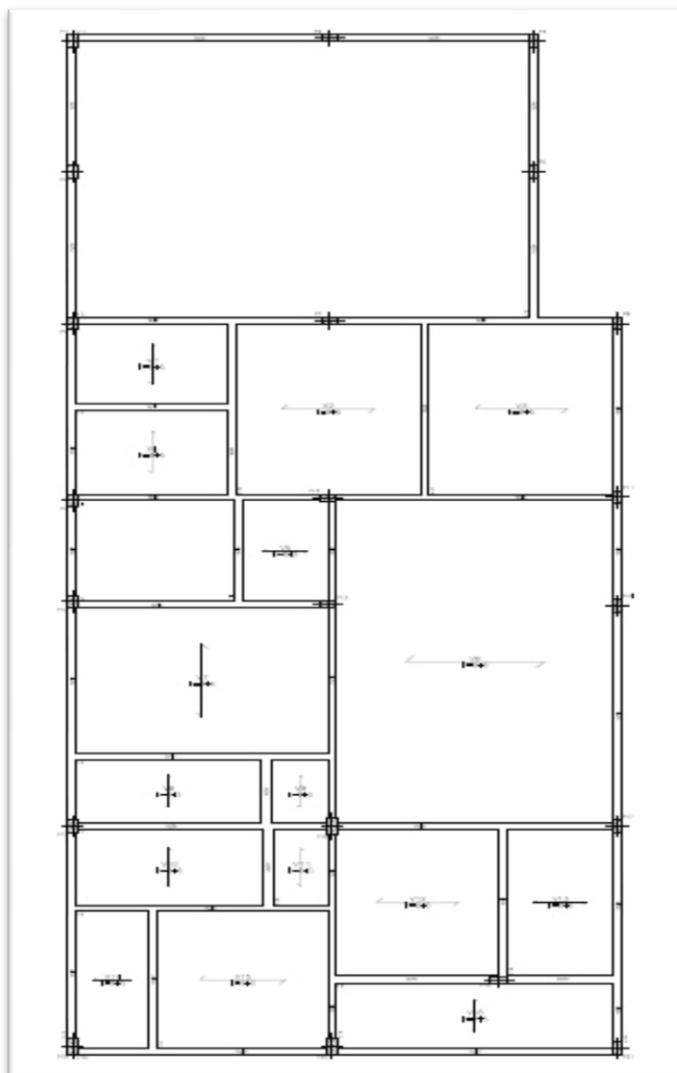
Fôrmas de vigas e indicação das lajes do pavimento superior
